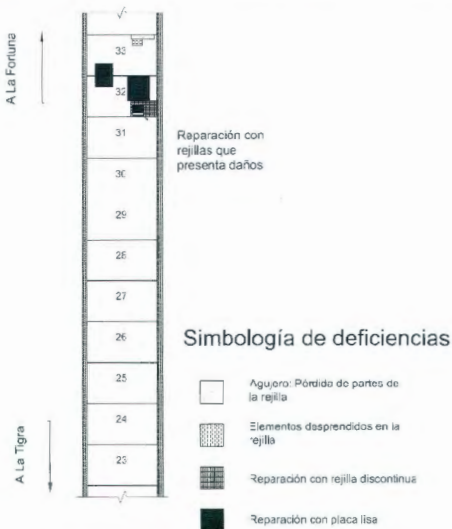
Figura O. Diagrama del tablero del puente donde se resalta la ubicación de los paneles con daño. Vista de los paneles 23 al 33.
